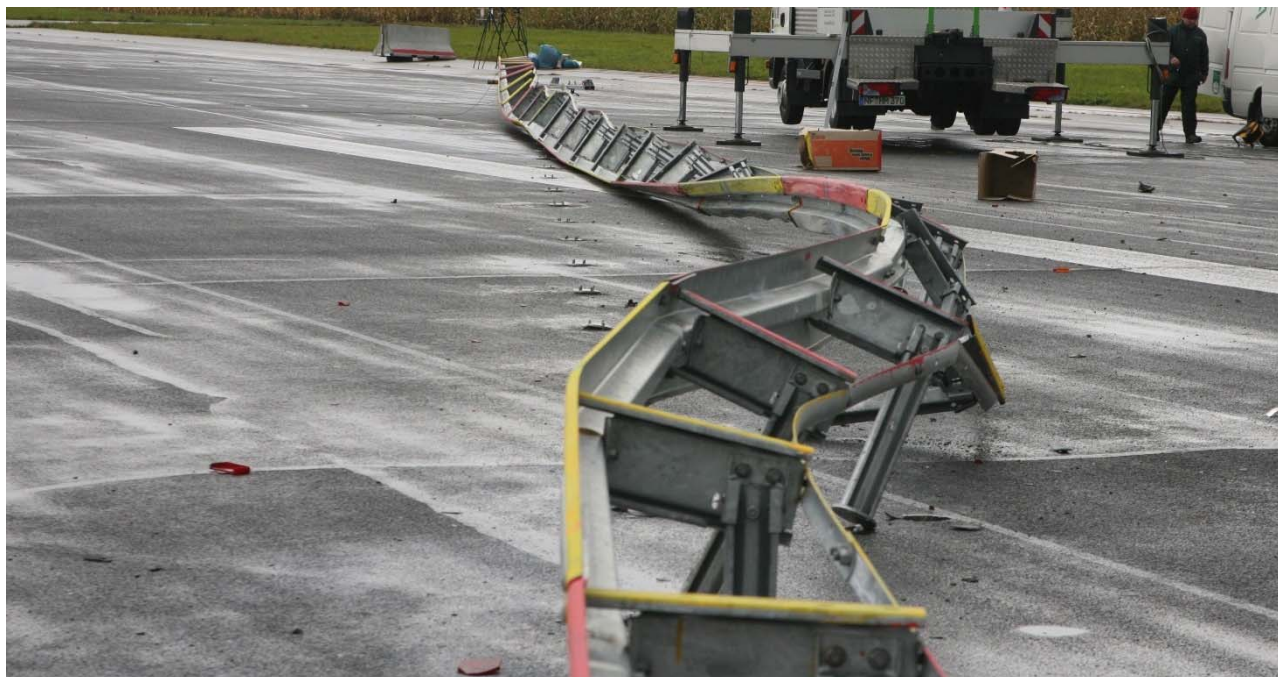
Schutzeinrichtung nach Crash (Ansicht Systemvorderseite entgegen Anprallrichtung)
